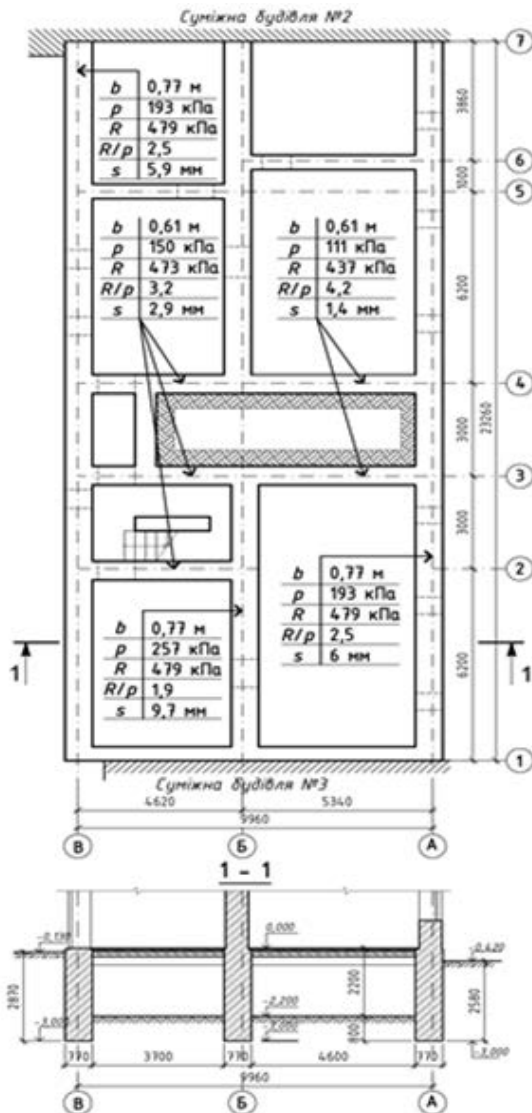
План фундаментів із поперечним перерізом та результатами перевірних розрахунків на етапі до початку виконання будівельних робіт
